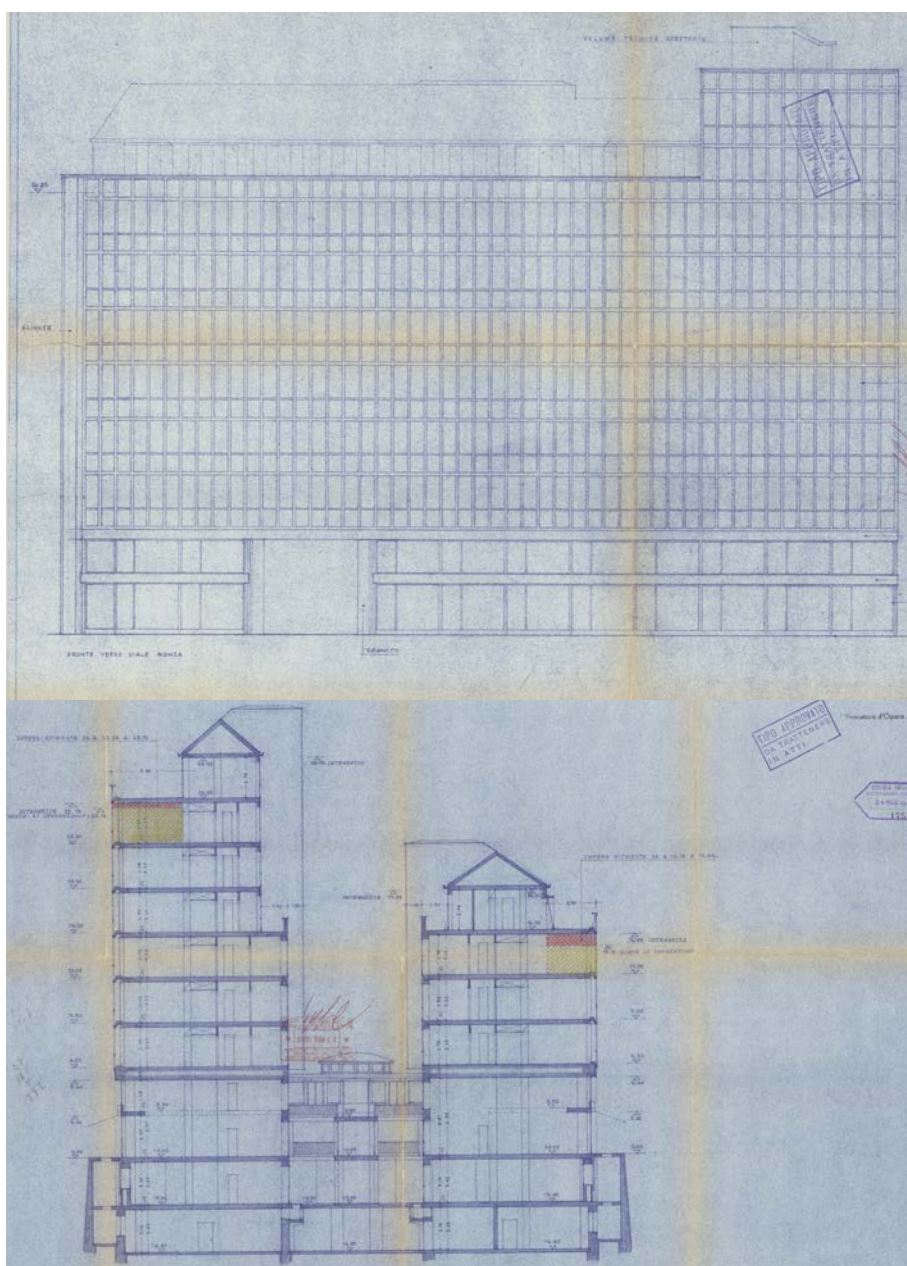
Un prospetto e una sezione del progetto originale, recuperati alla Cittadella degli archivi di Milano
